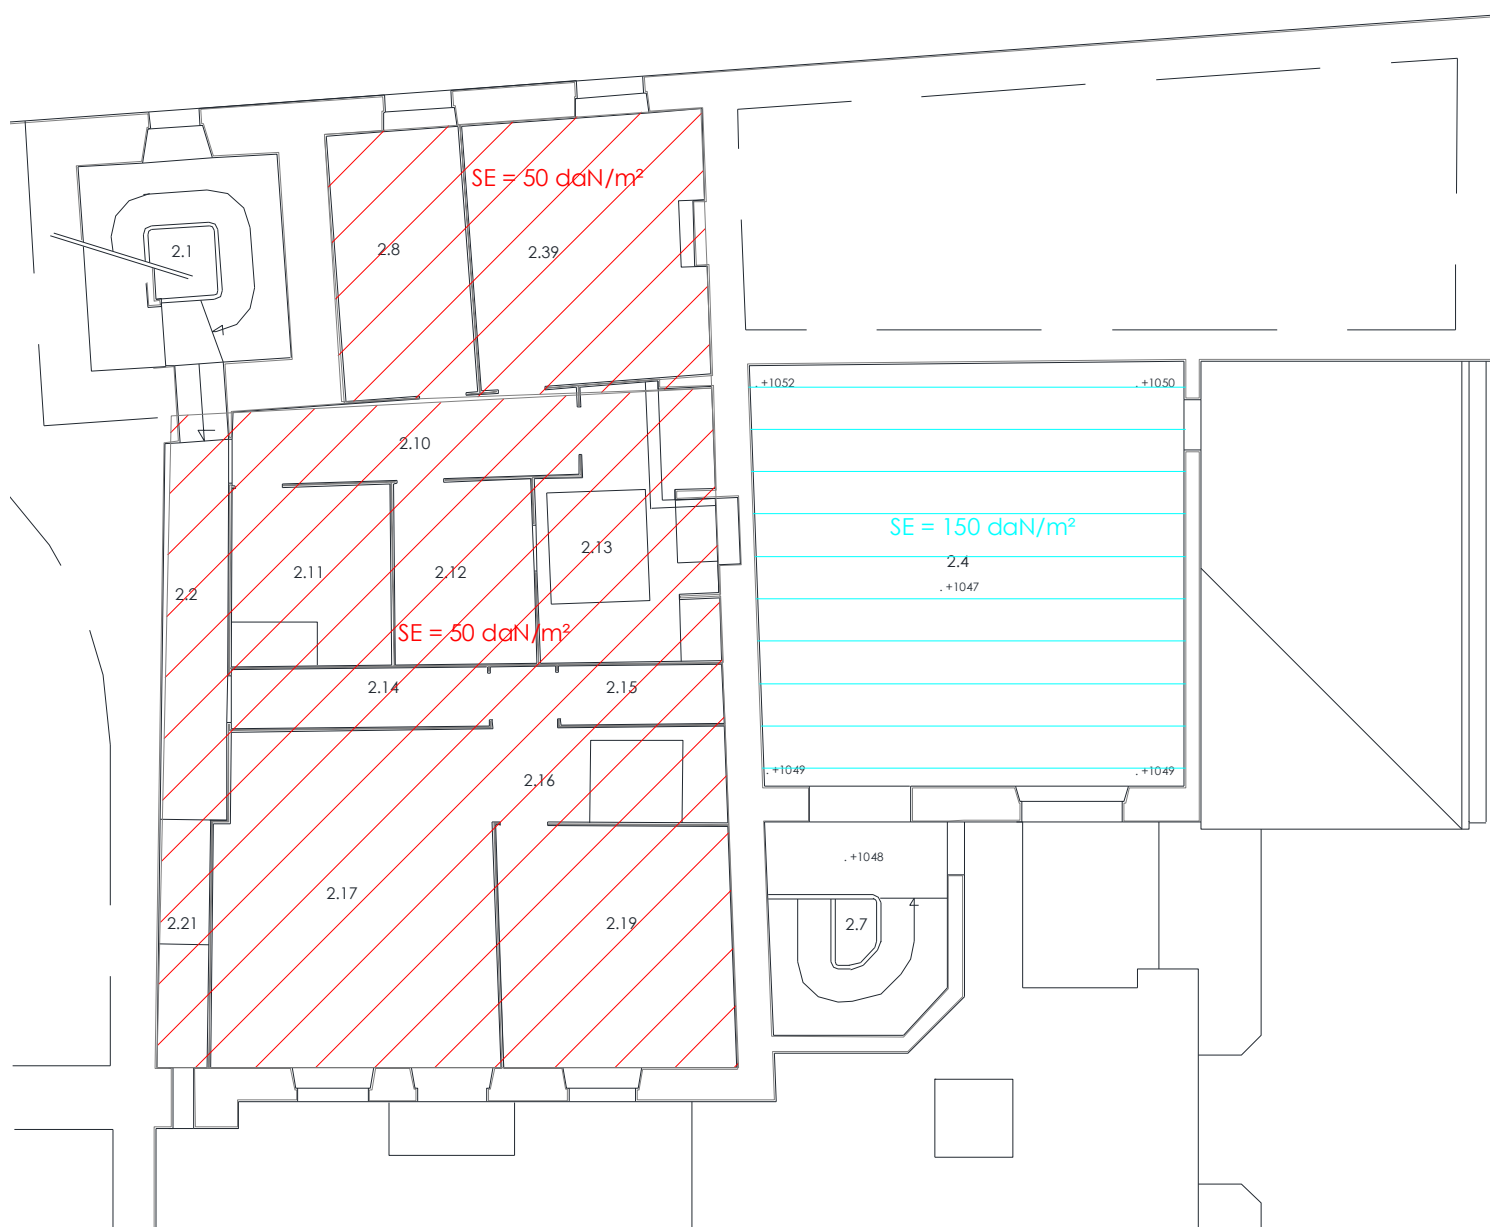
Vue en plan du second étage – Charges d'exploitation admissibles des planchers
